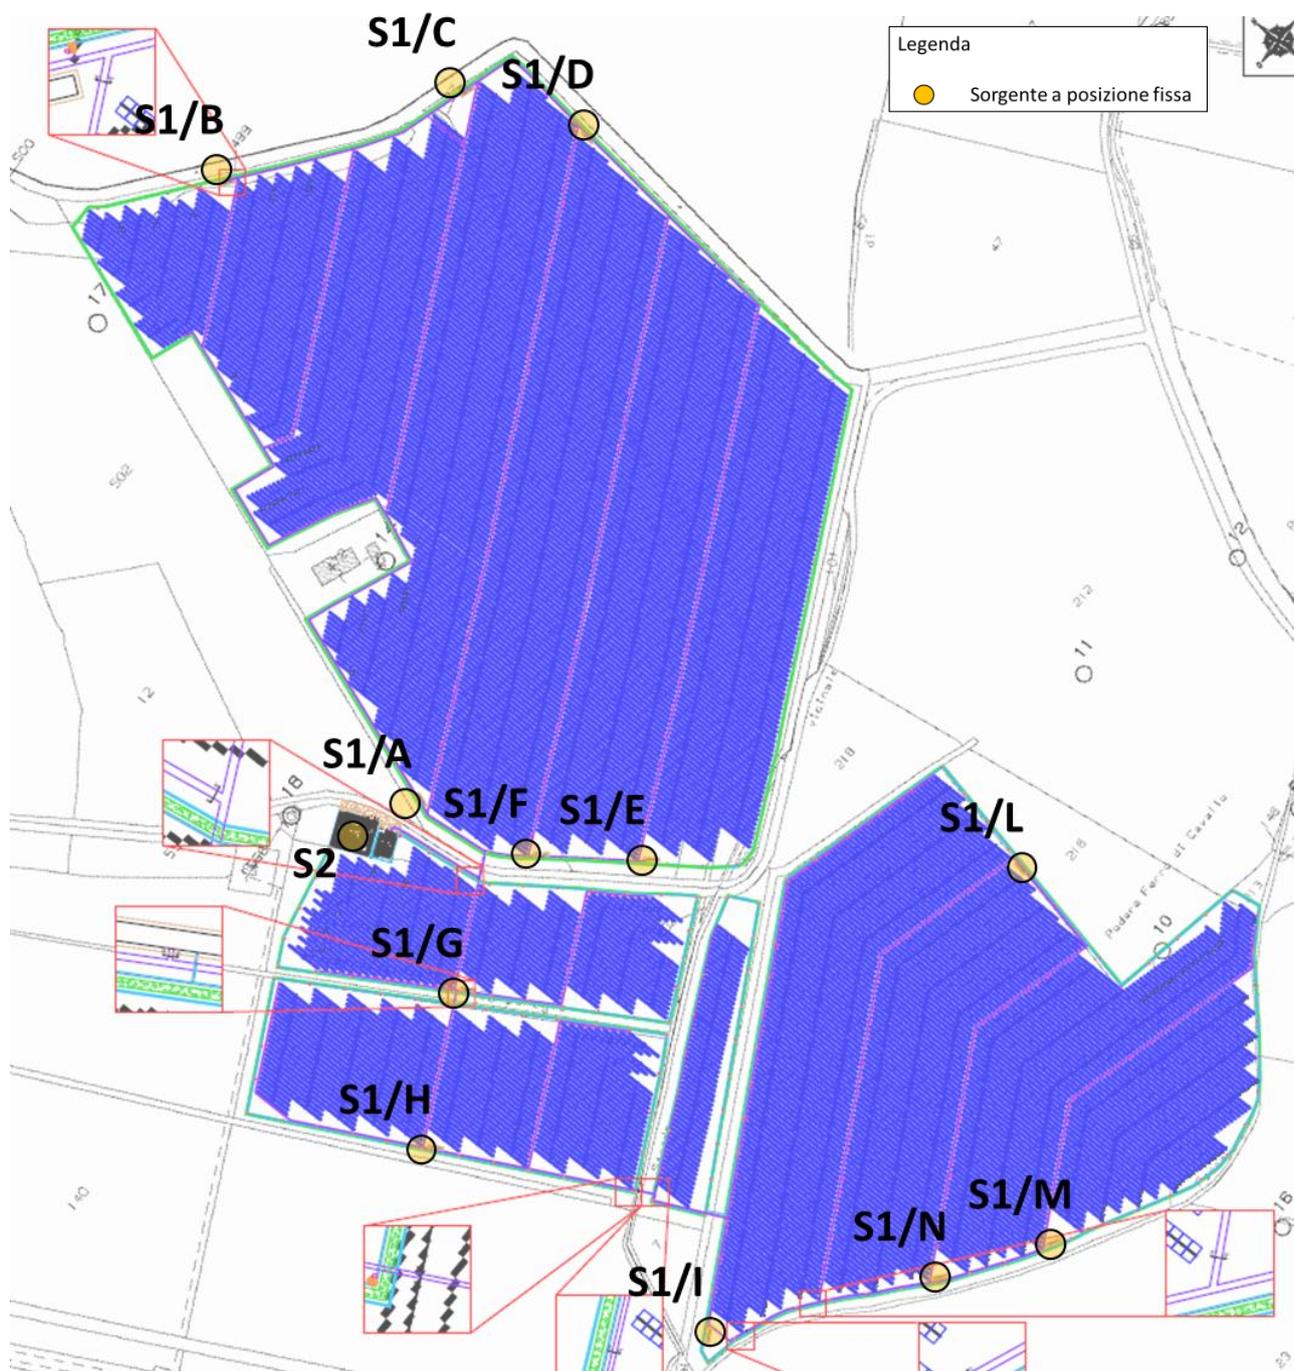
posizione delle sorgenti nella fase di cantiere (Estratto da All. 4)
